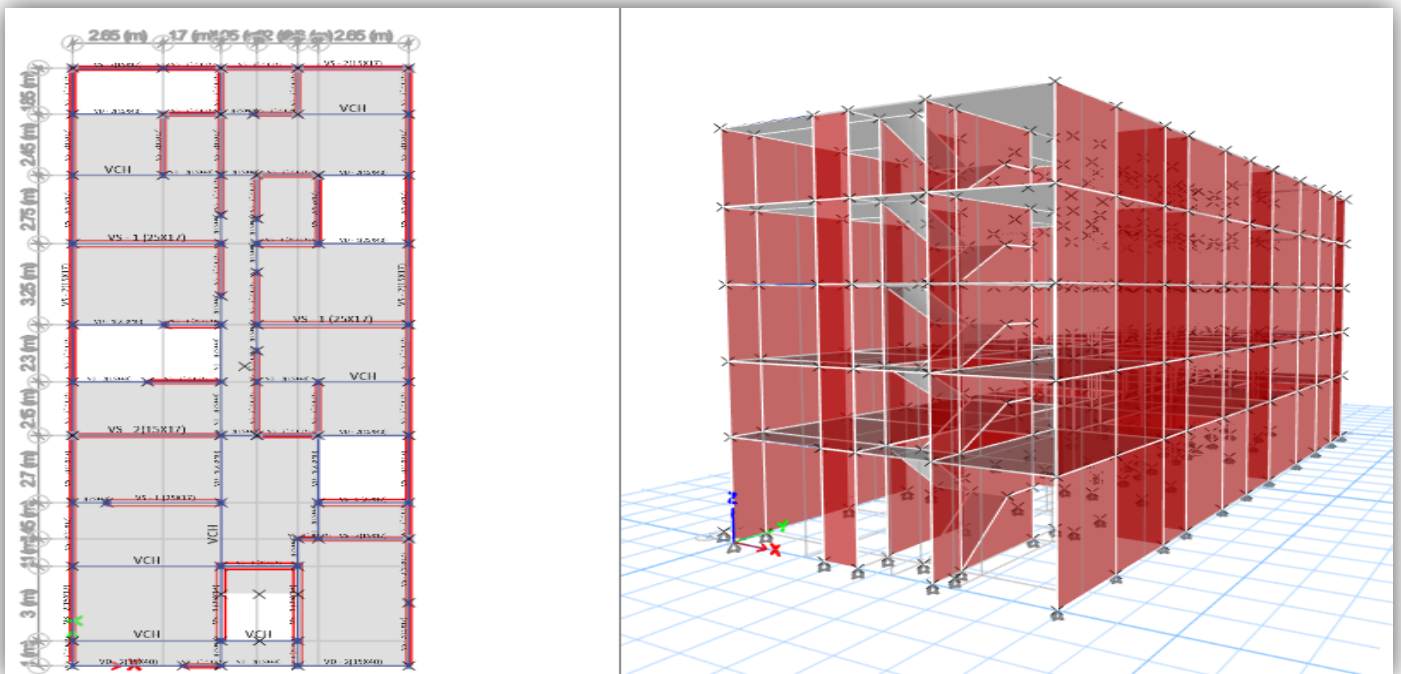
Modelamiento de elementos estructurales, Etabs 2016
